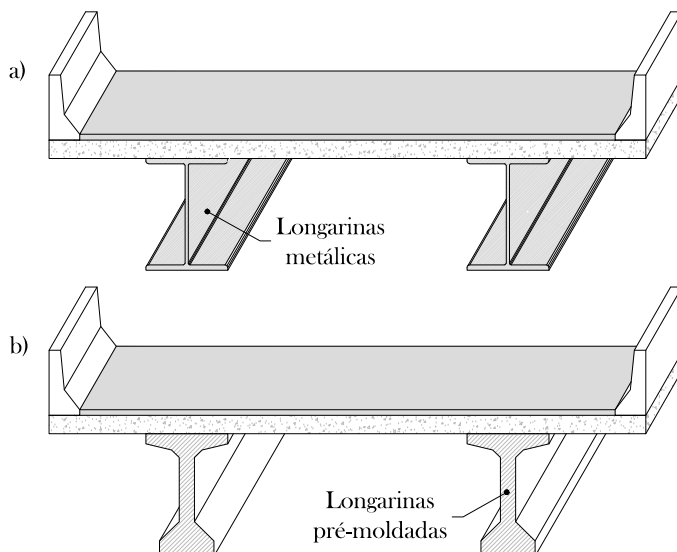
Seção para pontes em viga: (a) vigas metálicas; (b) vigas pré-moldadas.
